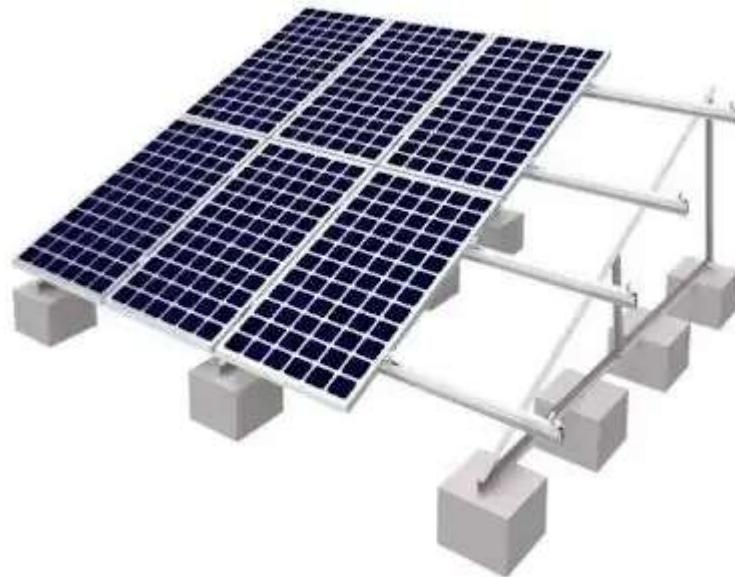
Estructura de Estructura de soporte en techo de losa o plafón.
